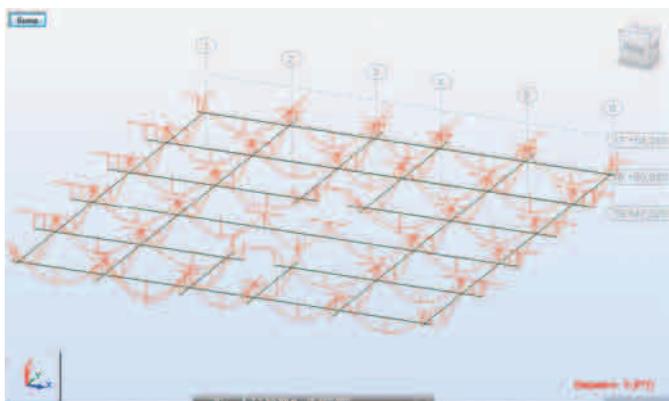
Арматурные канаты с нагрузкой от постнапряжения
